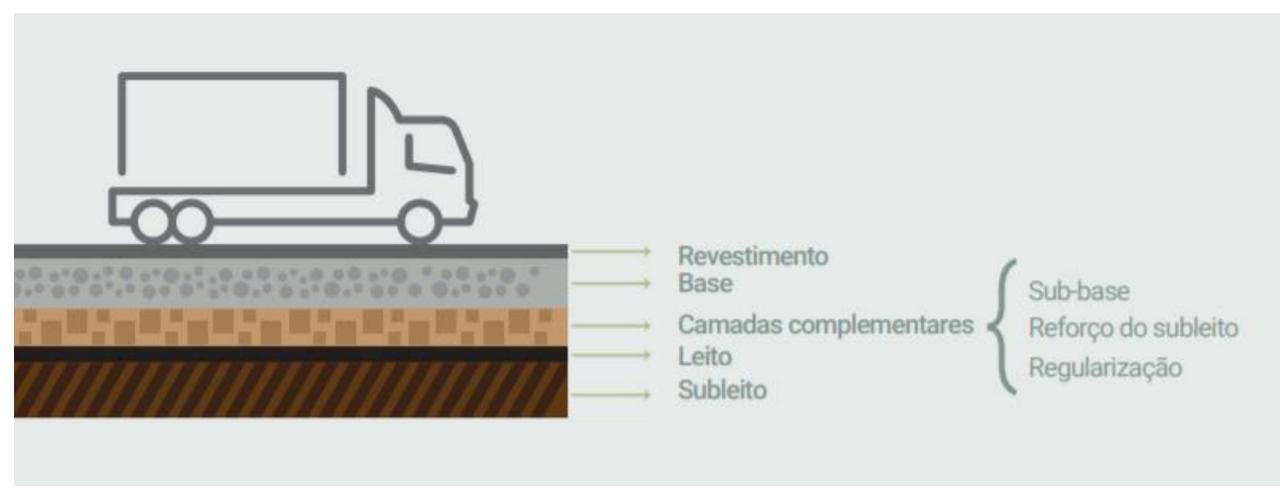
Disposição das camadas de pavimento. Fonte: CNT (2019).
